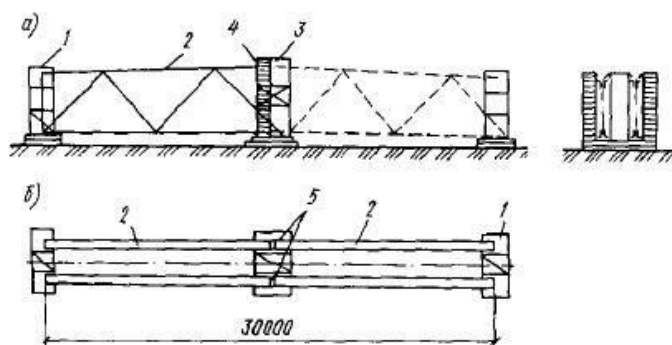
Схема организации рабочего места сборщика монтажных ферм. а) место для установки первой полу фермы, б) вид в плане, 1) крайний кондуктор, 2) полуферма, 3) средний кондуктор, 4) лестница с площадкой для сборки фермы, 5) место сборки стыка фермы.
